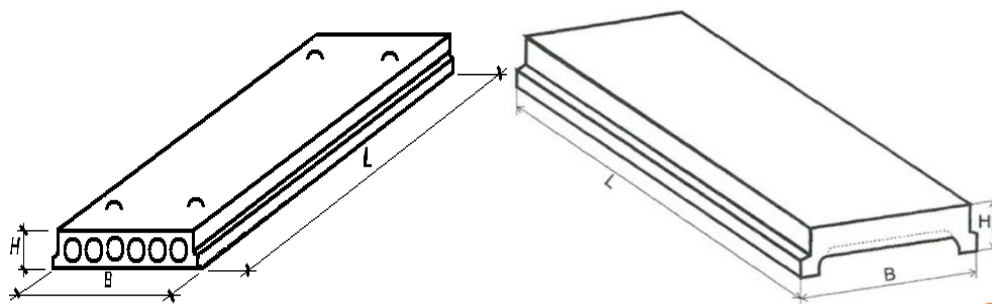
Конструкции плит перекрытий и покрытий
